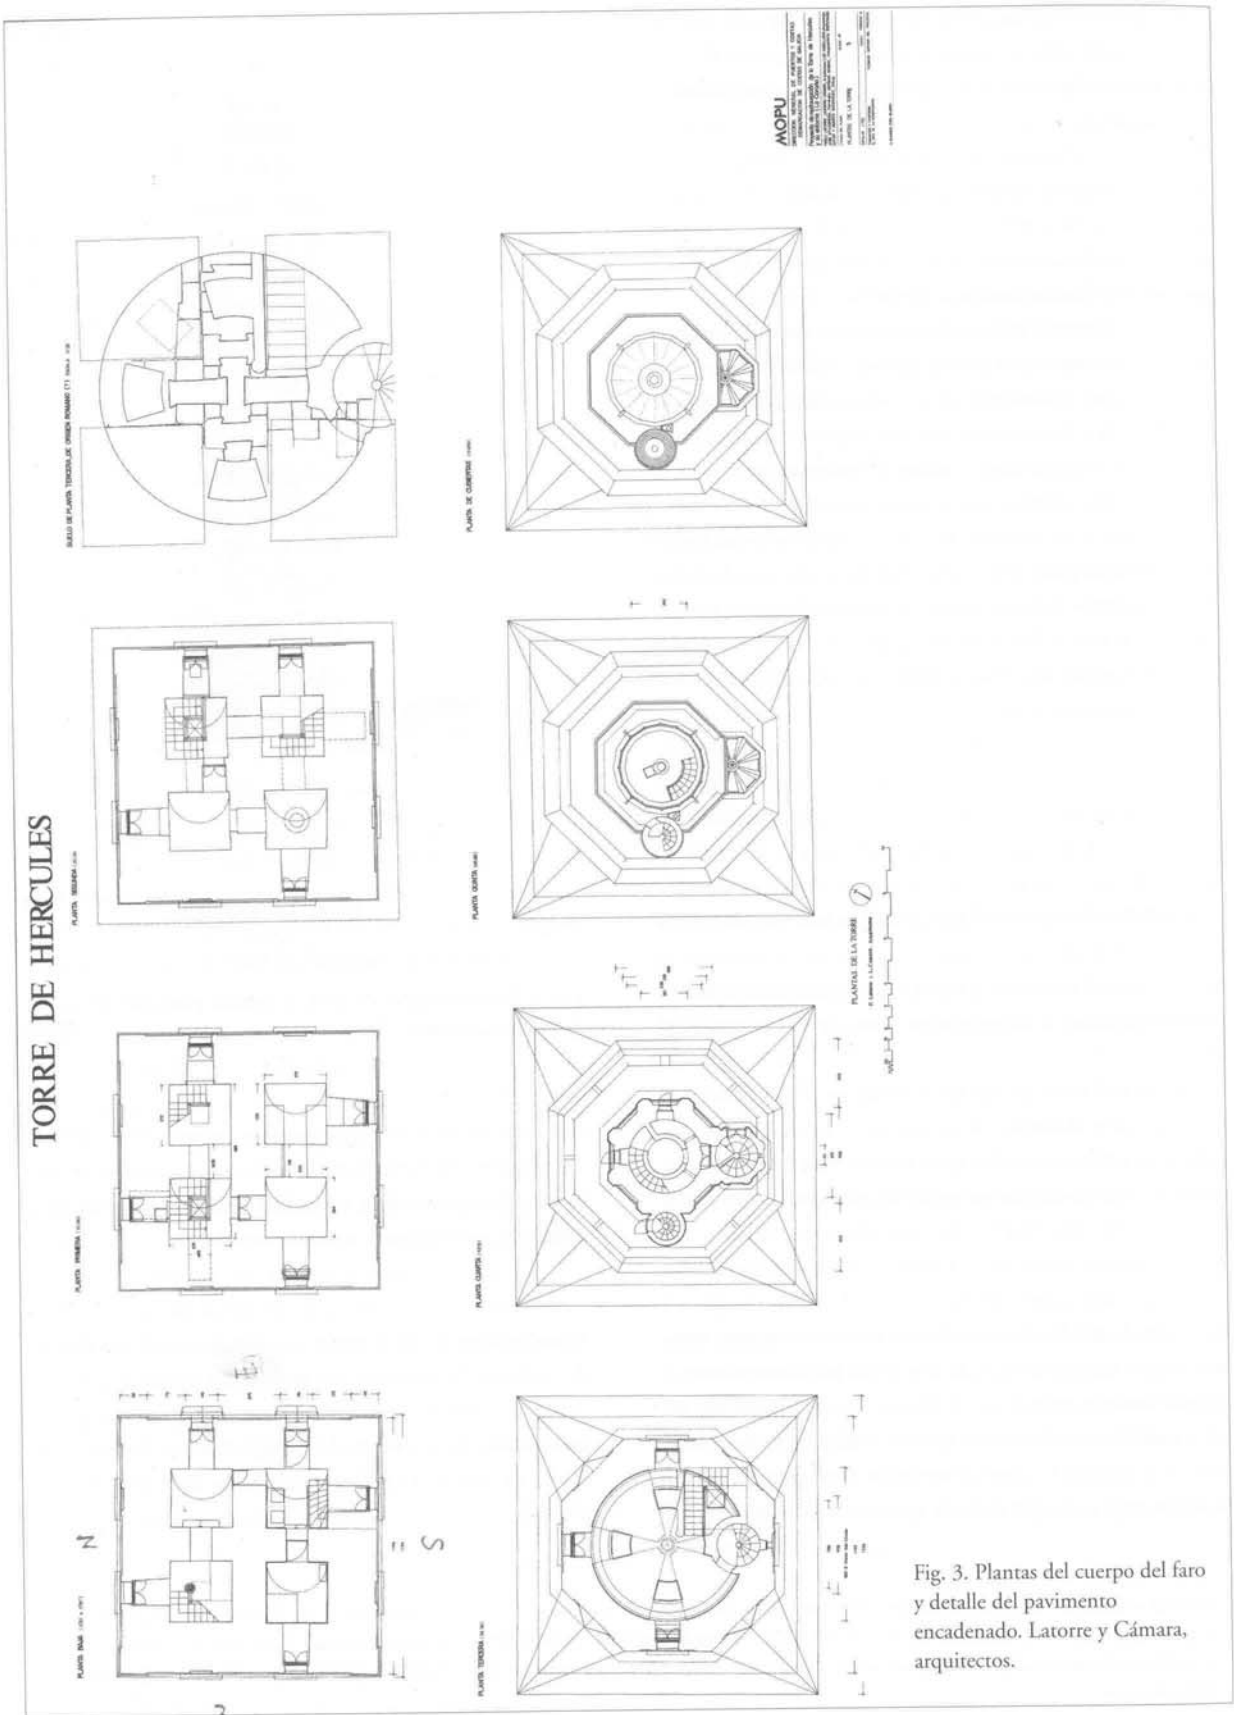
Plantas del cuerpo del faro y detalle del pavimento encadenado. Latorre y Cámara, arquitectos.
